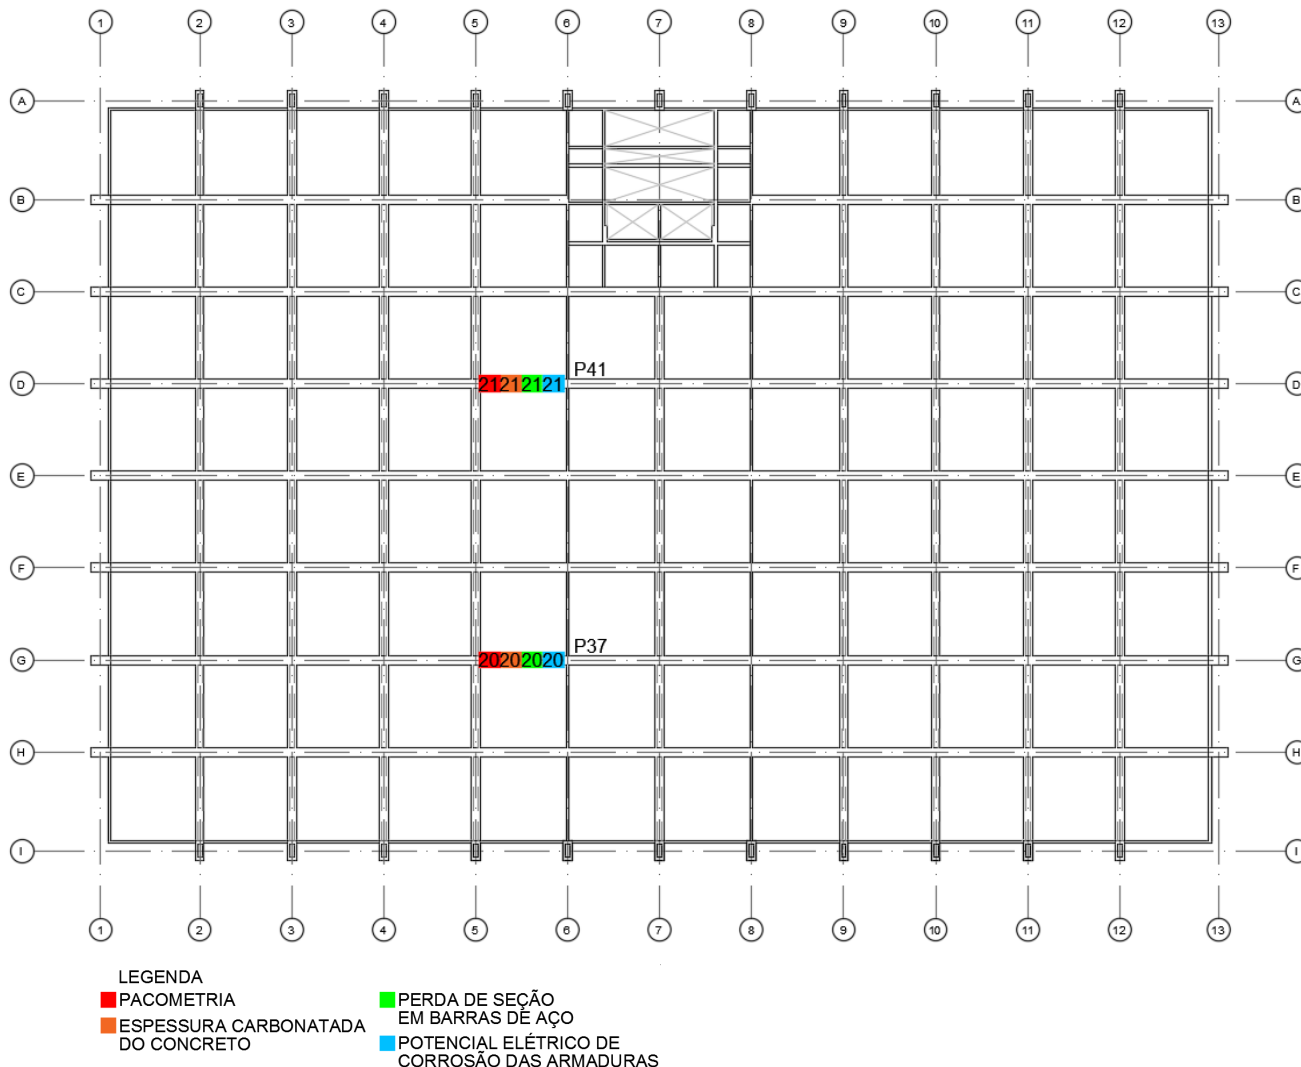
Croqui esquemático – Localização dos ensaios do 1º Pavimento
